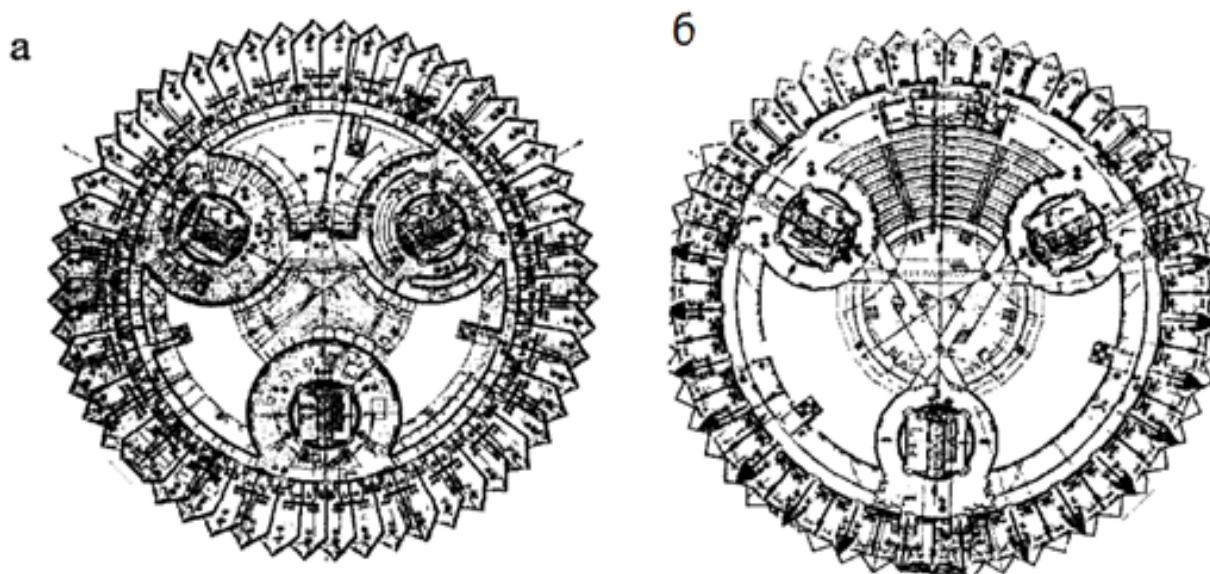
а – План первого этажа; б – план третьего этаж
